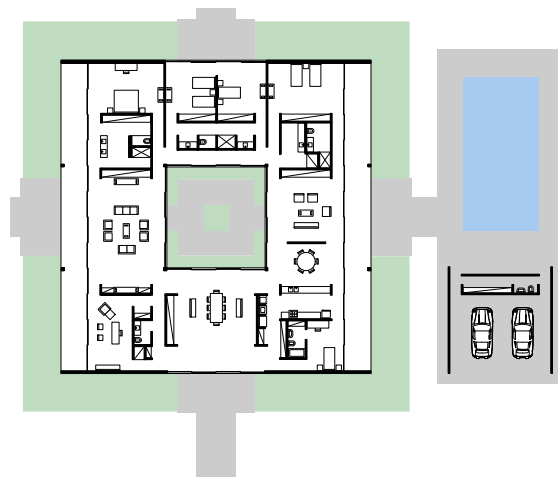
Planta baixa da Rosen House, de autoria de Craig Ellwood, 1963. Fonte: elaborado pelo autor.
